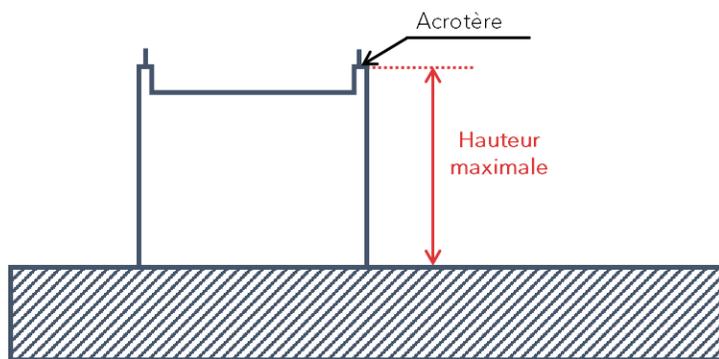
Cas d'une construction avec une toiture terrasse / plate
